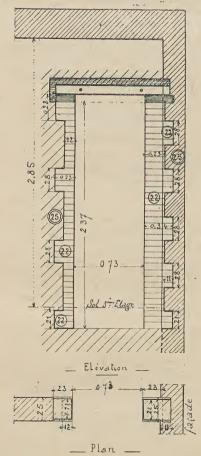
Elévation et plan des reprises par arrachement en brique.
